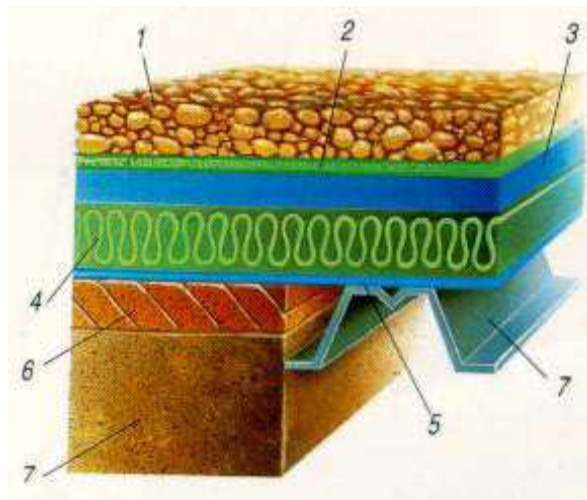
Cubierta con protección pesada con grava no transitable.
